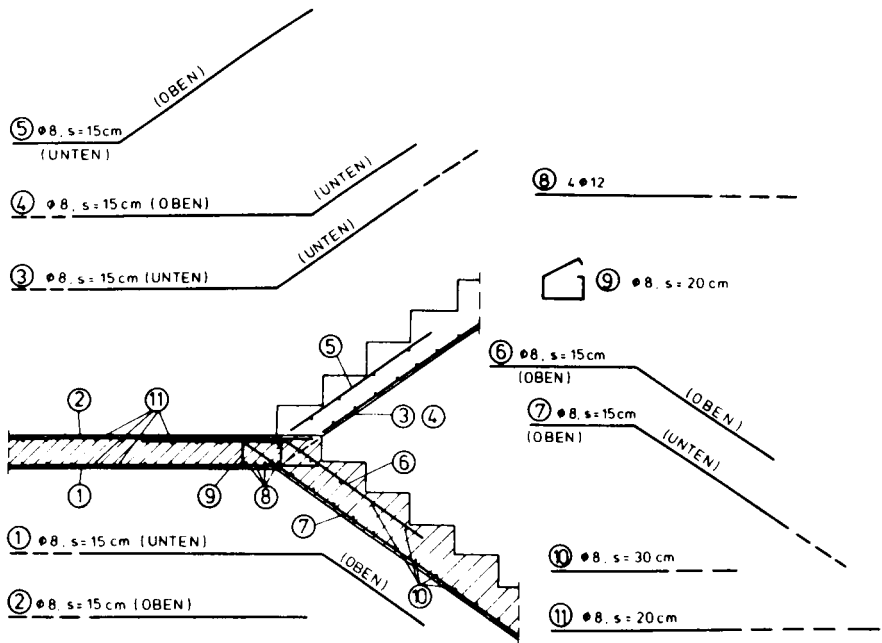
Bewehrung einer Treppe mit verstecktem Unterzug
